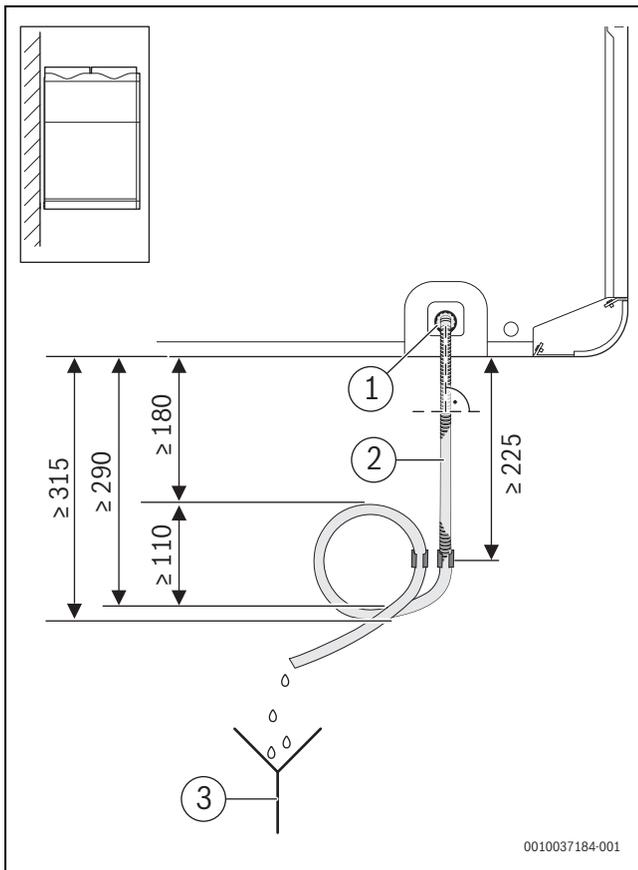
Mindestabstände mit Siphon HRV-CKS bei Wandinstallation HRV176...
